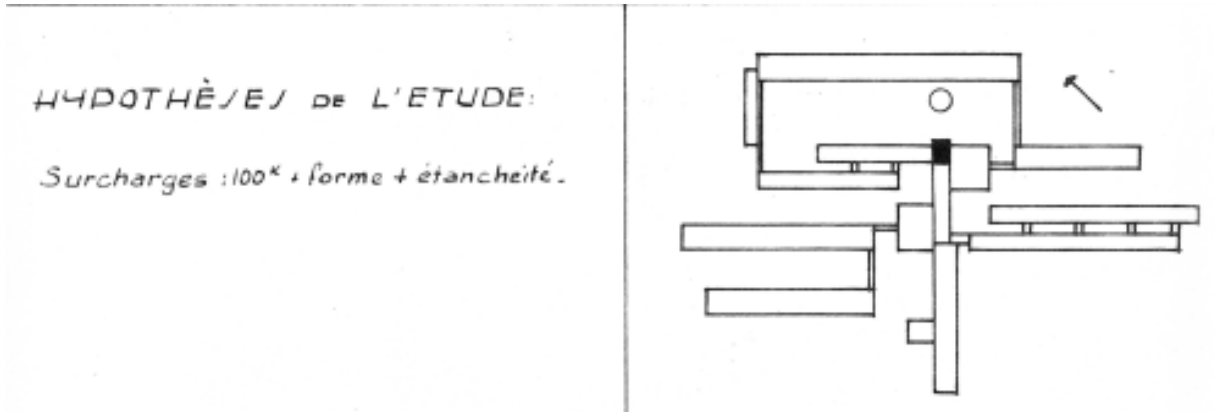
Extrait cartouche BA132, vue en plan terrasse bloc 1
